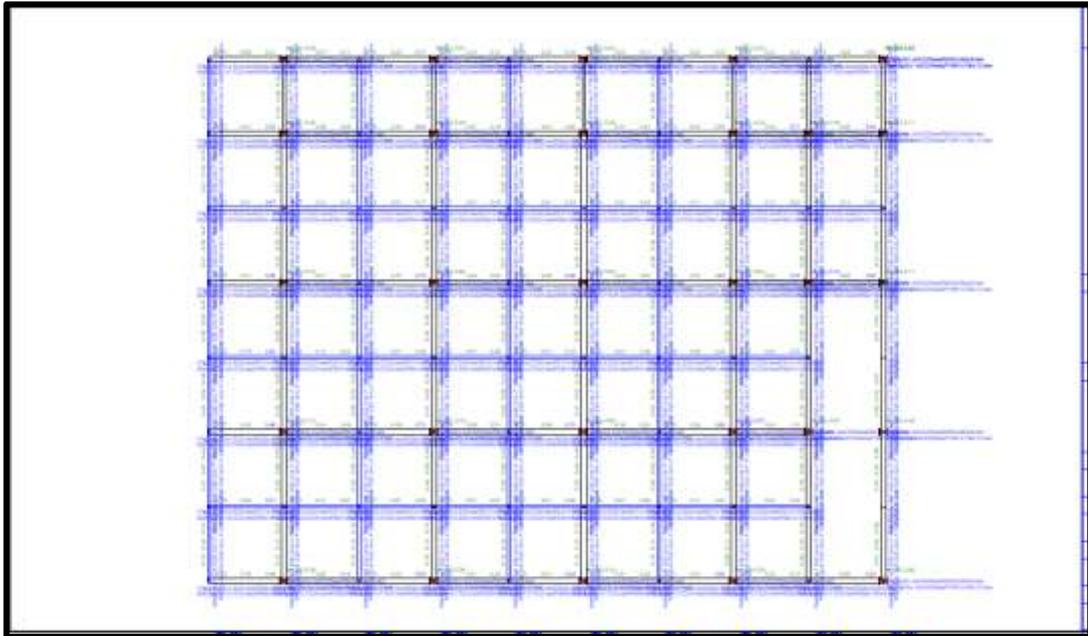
Layout Balok + 3.15 dan + 6.30
